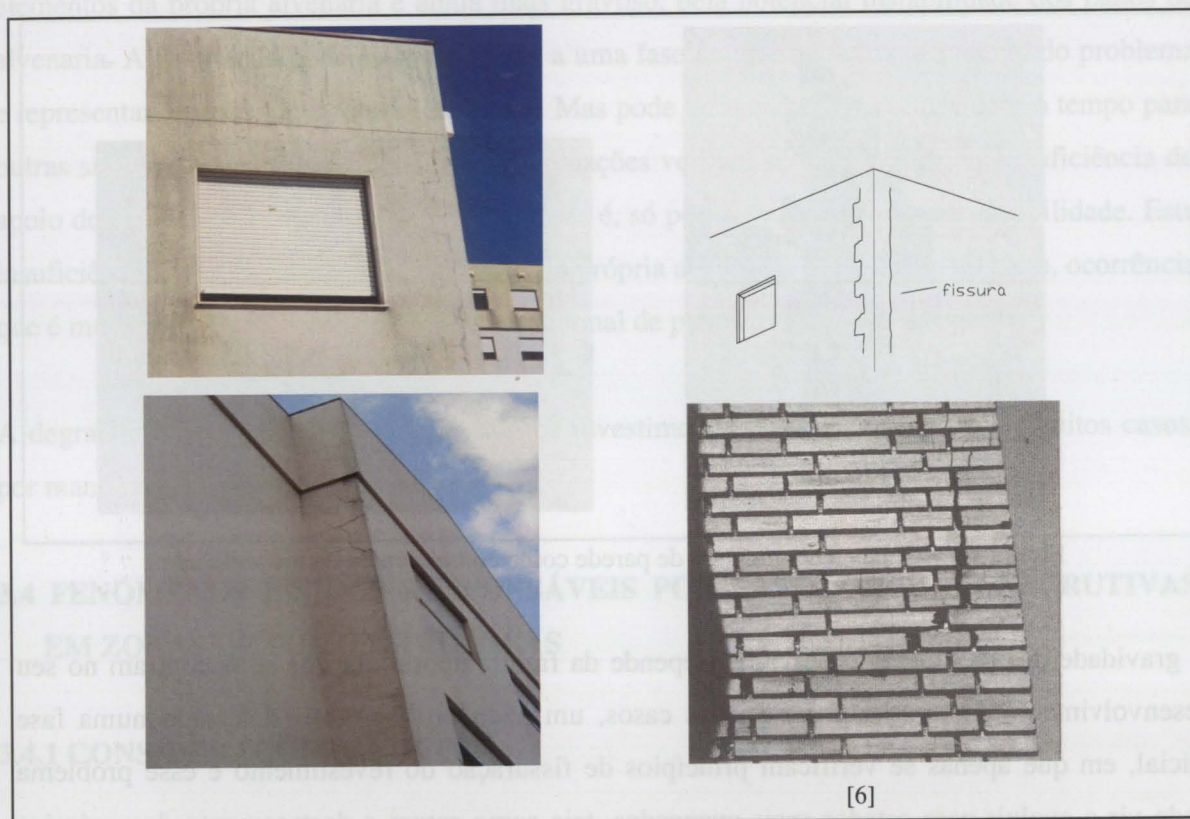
Fissuração dos revestimentos e da alvenaria em zona de cunhal
